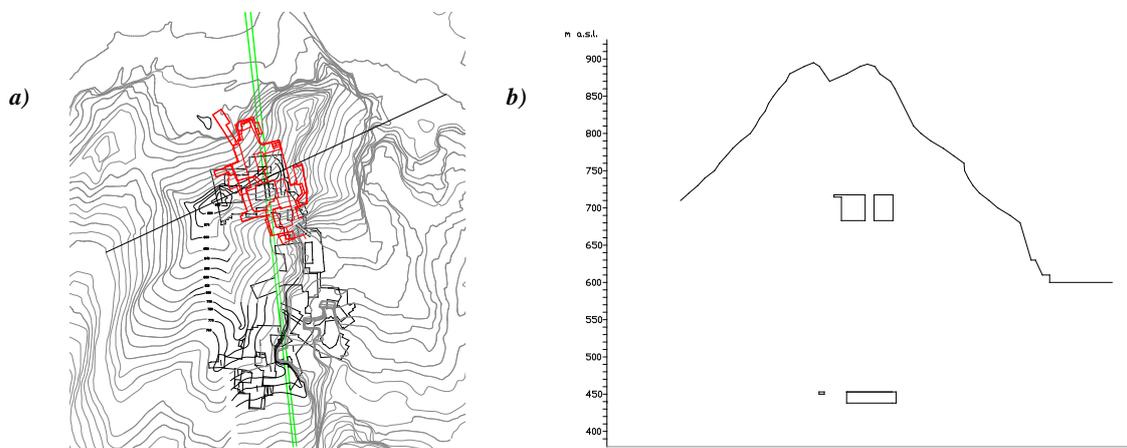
Planimetria (a) e sezione NE-SW (b) rappresentative dell'area oggetto di indagine
